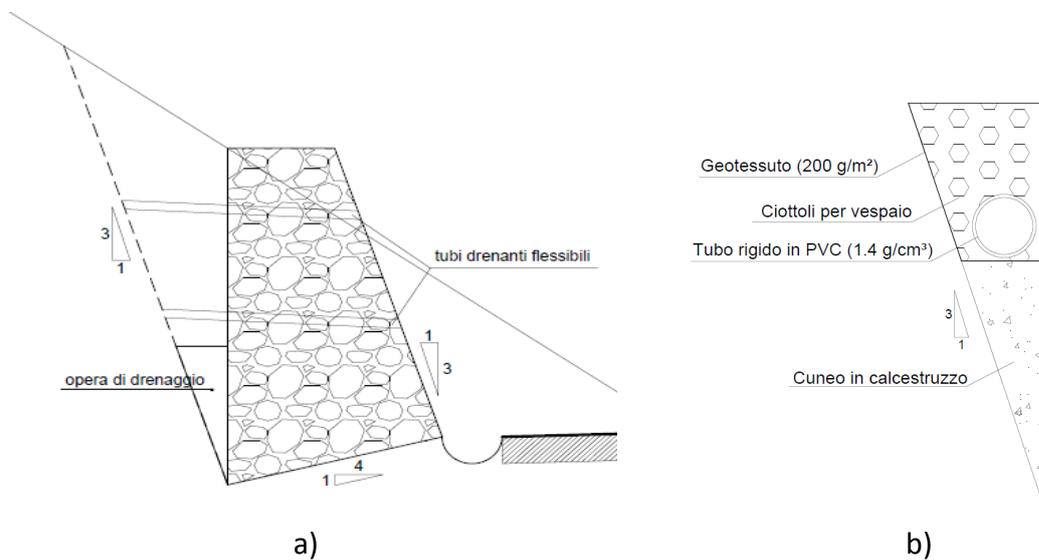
Schema del drenaggio a tergo dell'opera di sostegno: a) vista dell'opera di sostegno con tubi drenanti flessibili e drenaggio a tergo; b) particolare dell'opera di drenaggio
